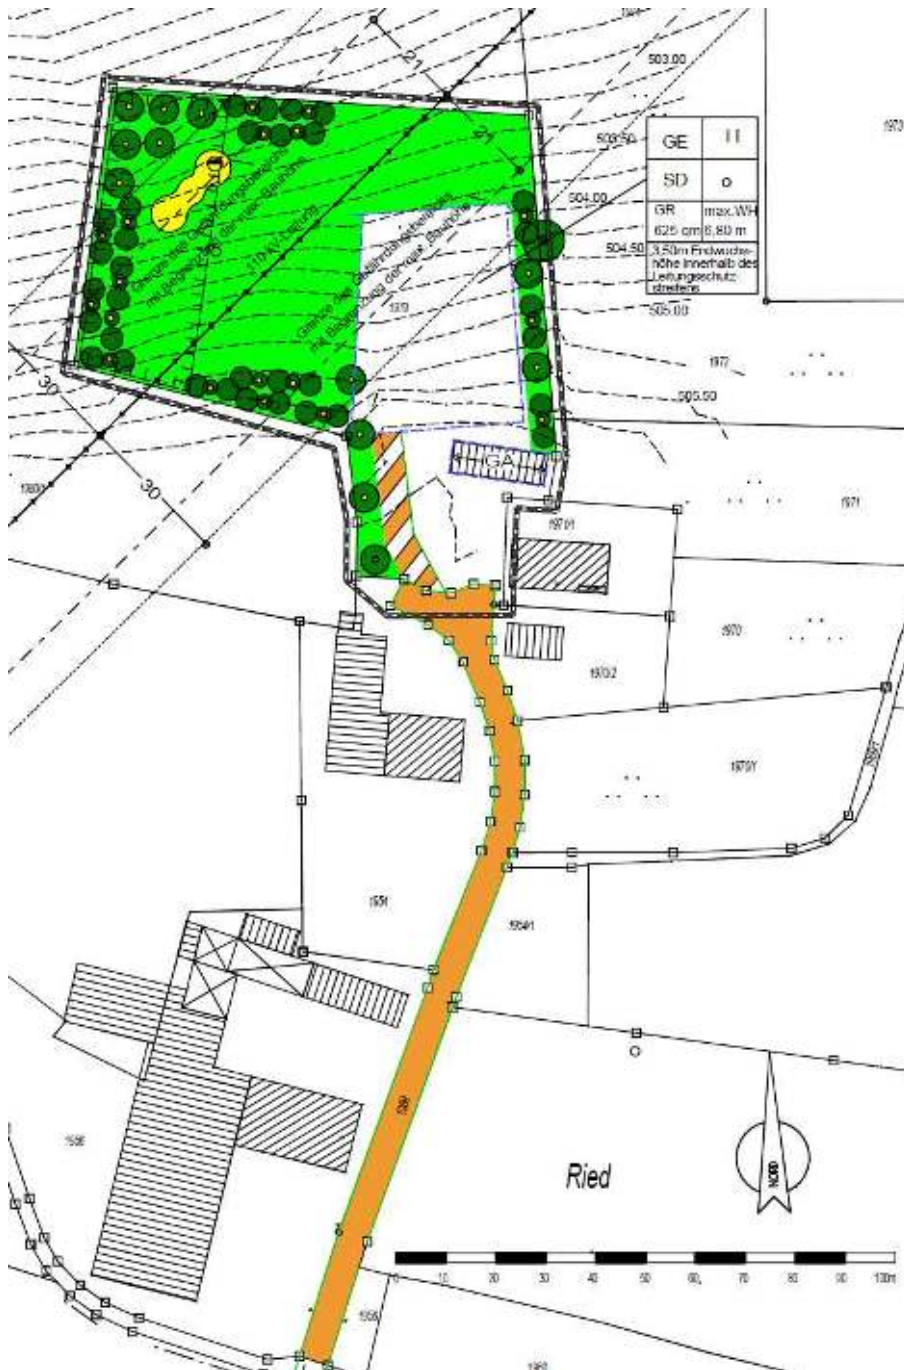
Ur-Bebauungsplan - ohne Maßstab!
